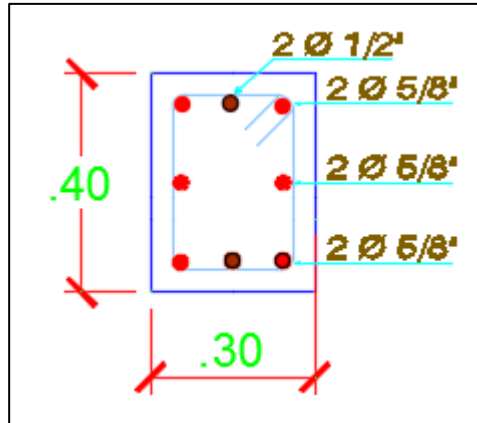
Sección Transversal Viga secundaria VS - 1. Fuente: Elaboración propia.
